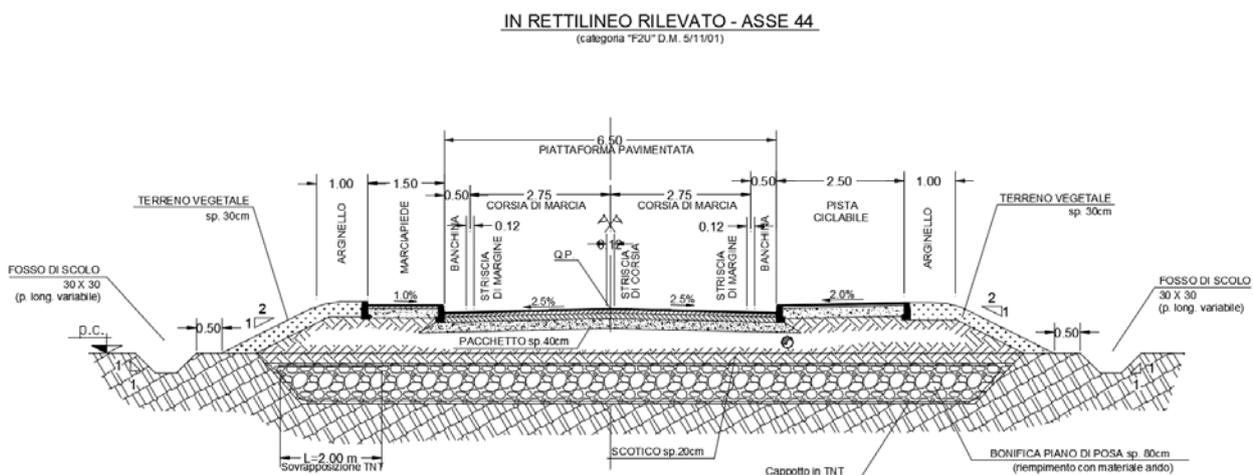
Sezione tipologica in rilevato dell'asse 44
